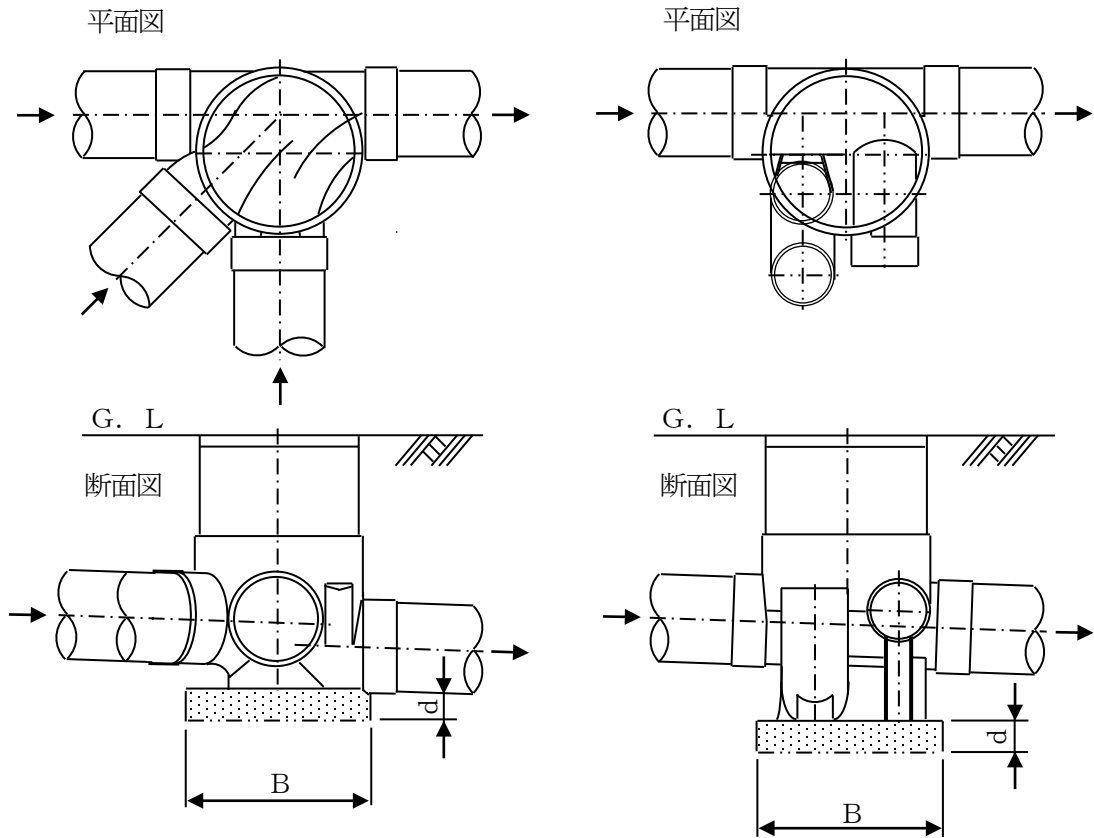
ますの内径φ200・管径φ100 の場合の平面図と断面図
